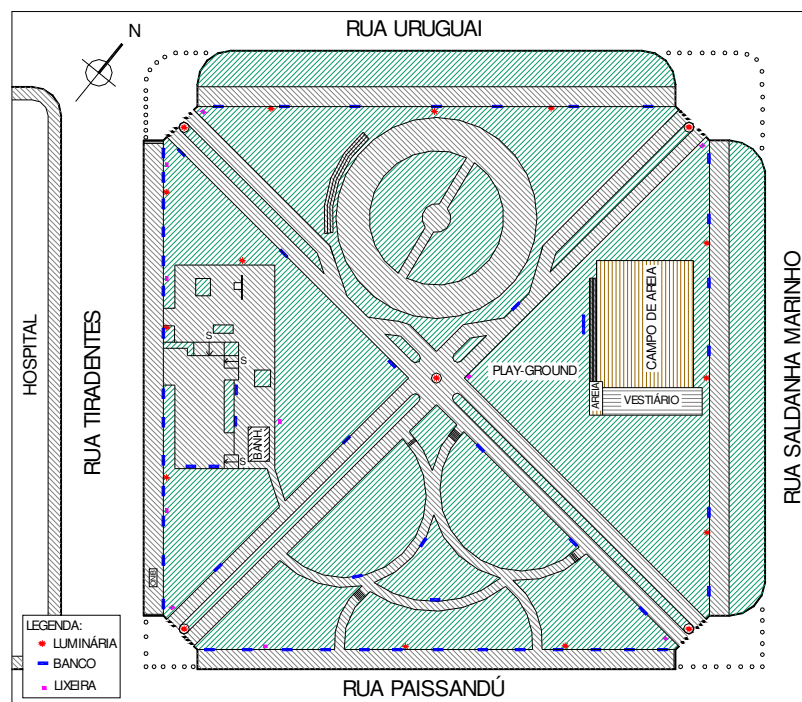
Planta Baixa da Praça Antonino Xavier de Oliveira
